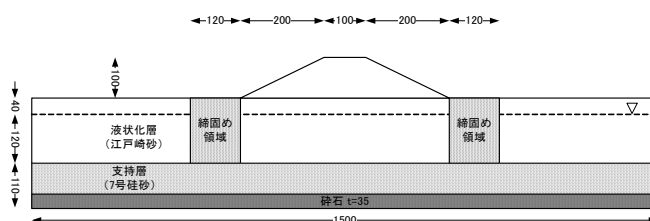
締固め実験模型概要 (H14-3、単位: mm)
